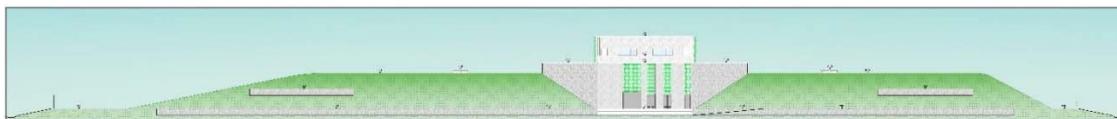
Prospetto Ovest (tratto da Progetto definitivo)
